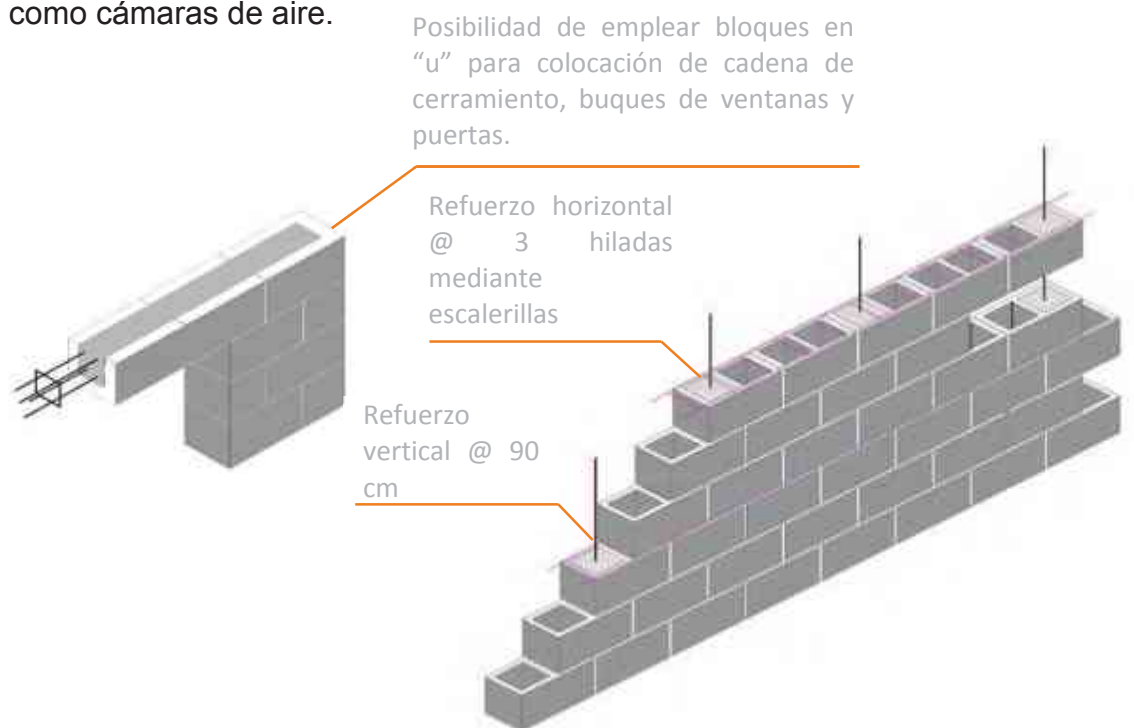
Croquis de aplicación de acero de refuerzo en muro de block hueco liso de concreto. Elaborado por DDM.
